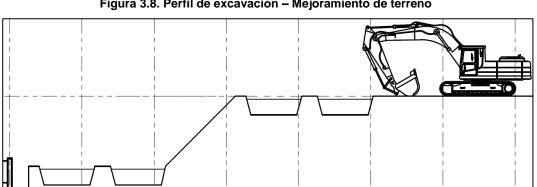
Perfil de excavación - Mejoramiento de terreno
